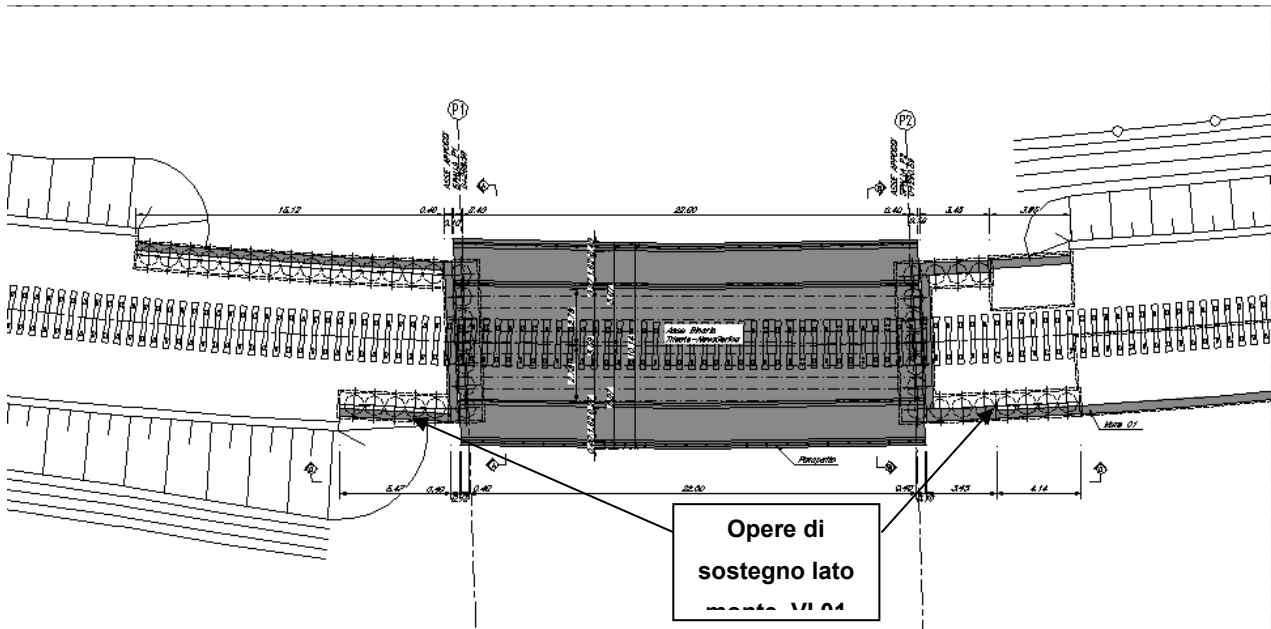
9: Planimetria con ubicazione dell'opera di sostegno lato monte.
